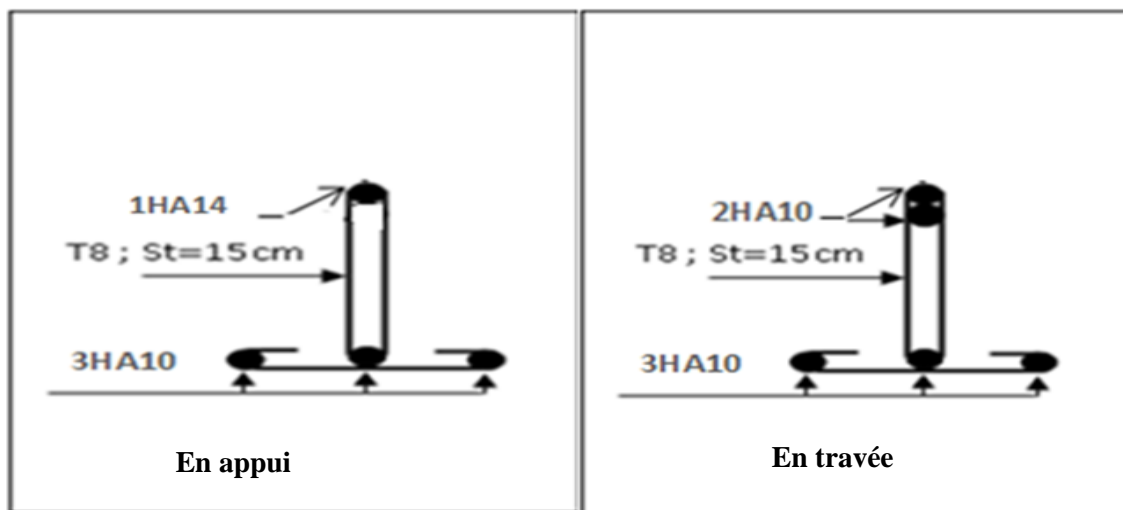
Schéma de ferrailage des nervures de plancher terrasse.
